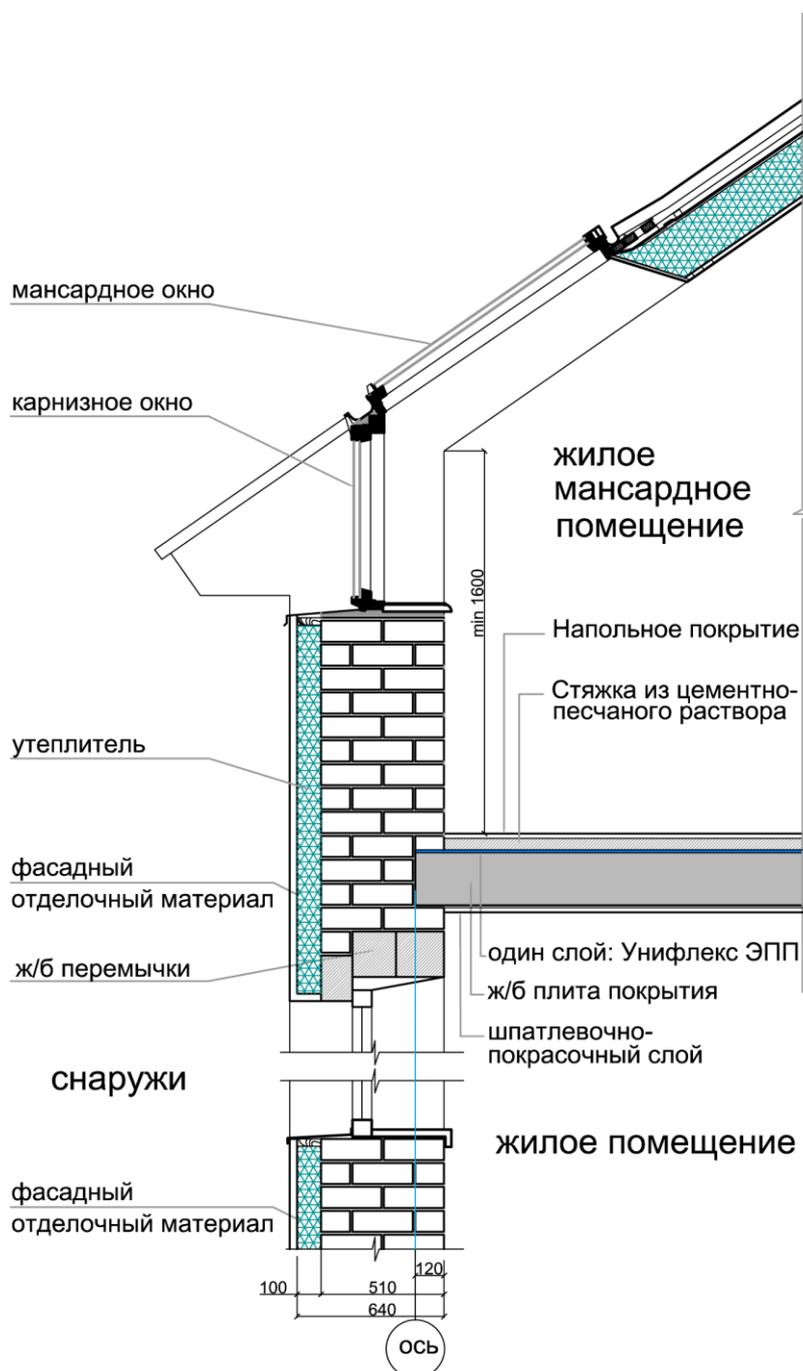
Узел скатной кровли с окнами в мансарде.
